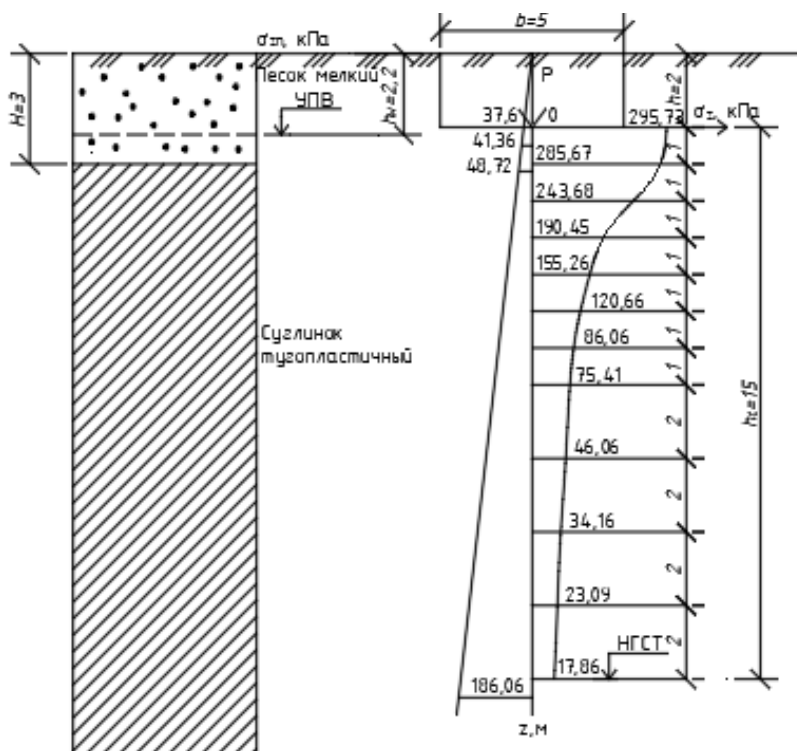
Схема для расчета осадки фундамента методом послойного суммирования
